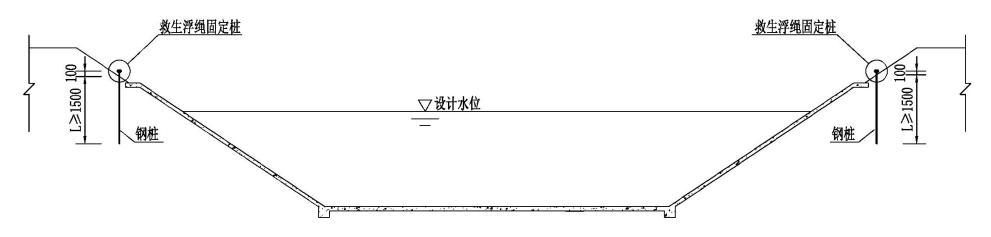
救生浮绳固定桩(A—A 剖面图,单位: mm)
